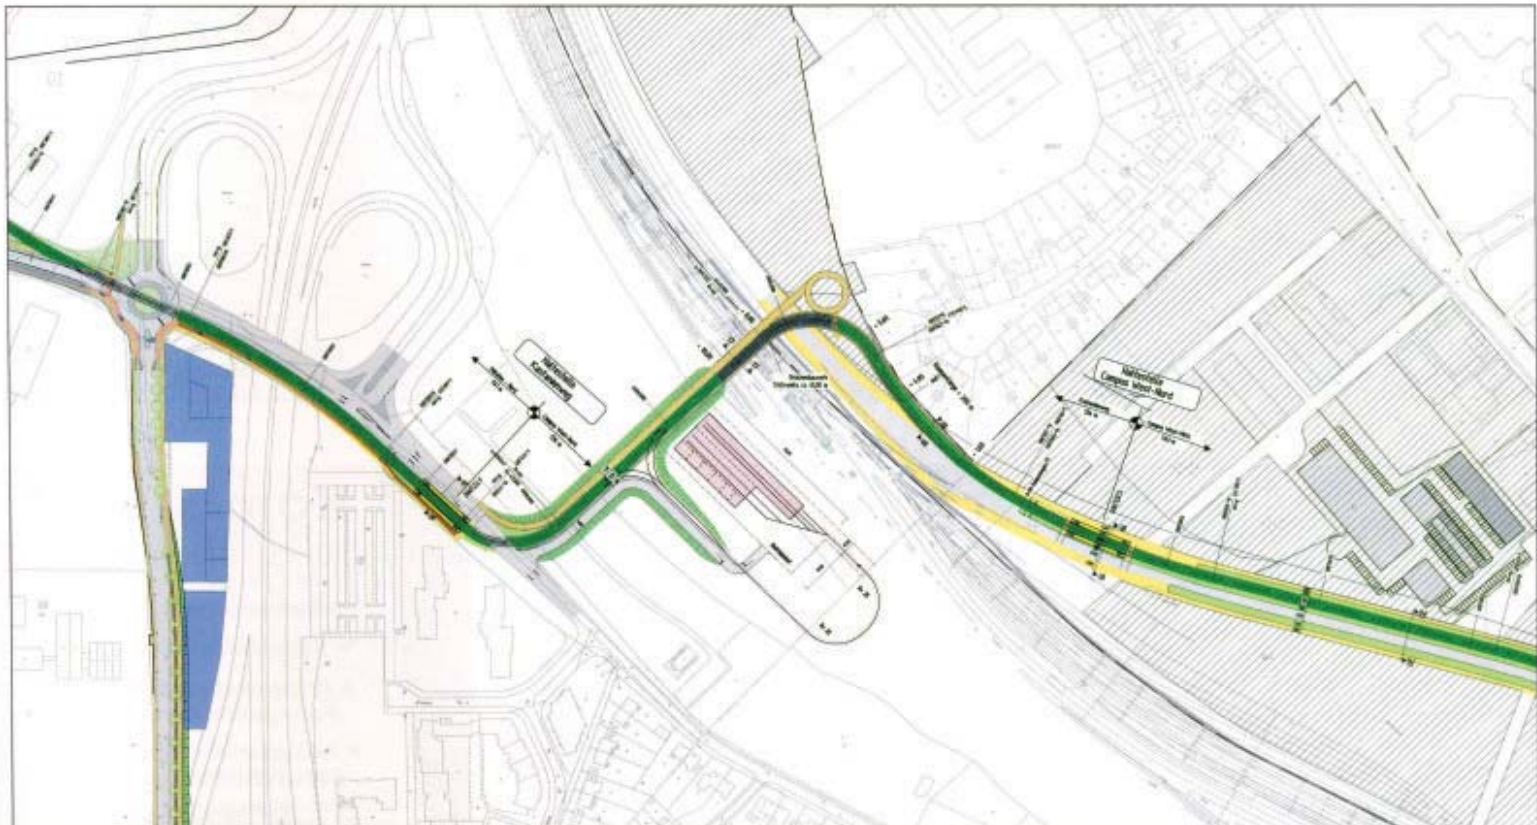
Beispiel Lageplanausschnitt Straßenbahn: Querung der DB-Gleise.
